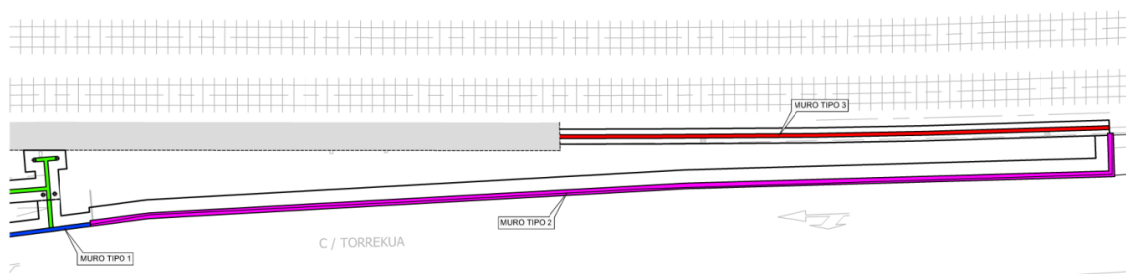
Planta de cimentación y muros de zona de ampliación de andenes
